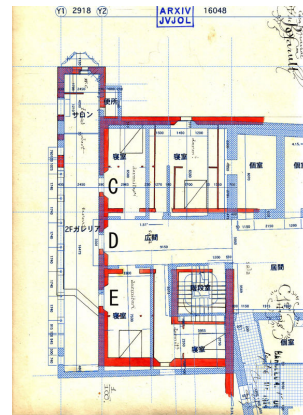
ジュジョール自身による改築前2階平面図と現状の実測2階平面図との比較
